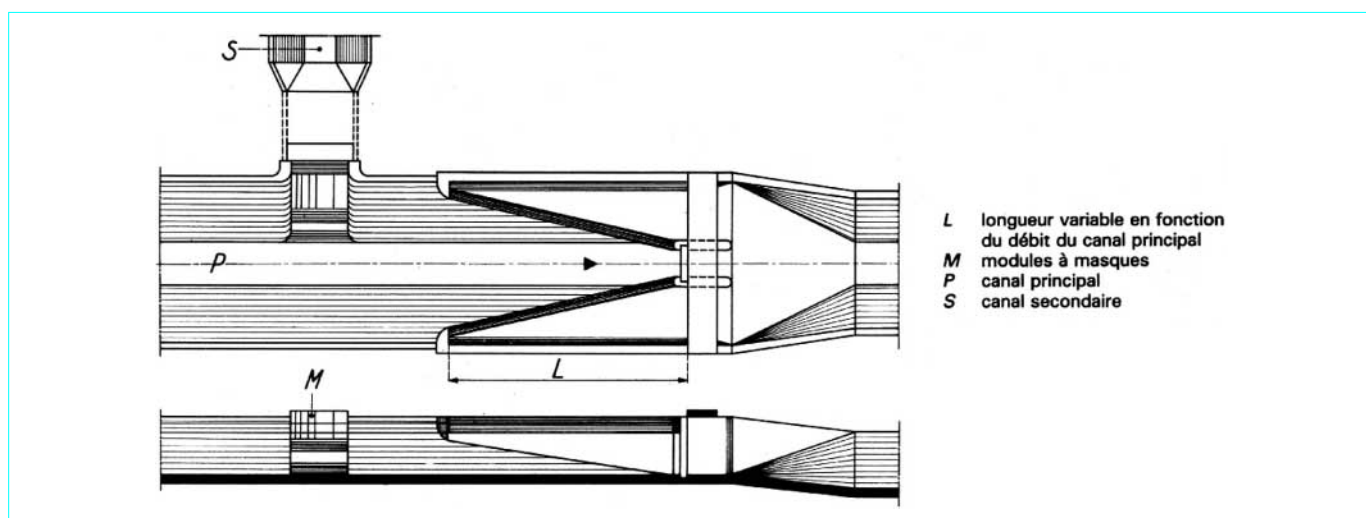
Ouvrage de prise de canal secondaire sur canal principal (vue en plan et coupe selon profil en long)
